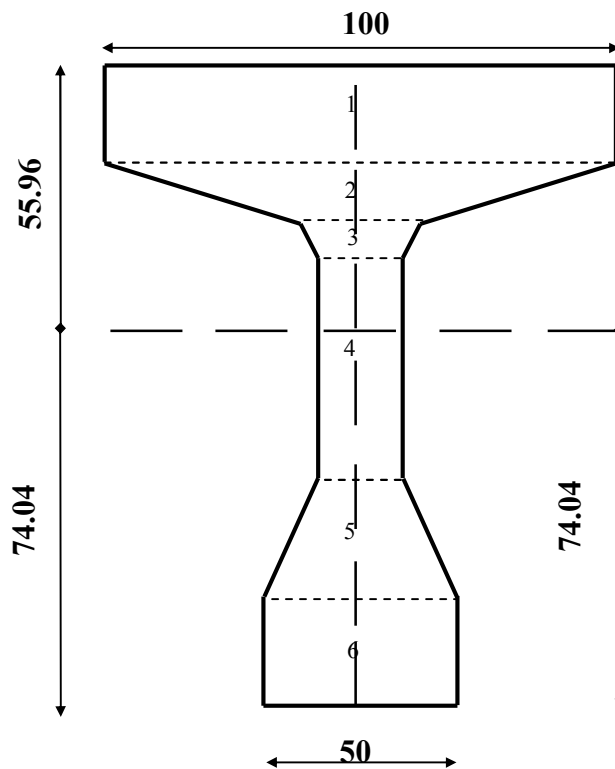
Dimension de la poutre mi travée sans dalle.
